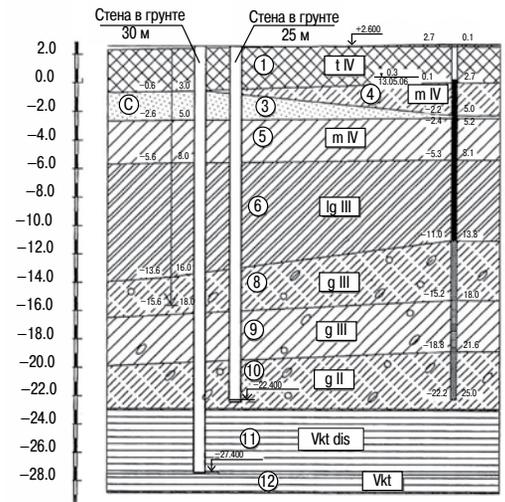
Схема расположения ограждения «стена в грунте» в грунтовых условиях основания строительной площадки
